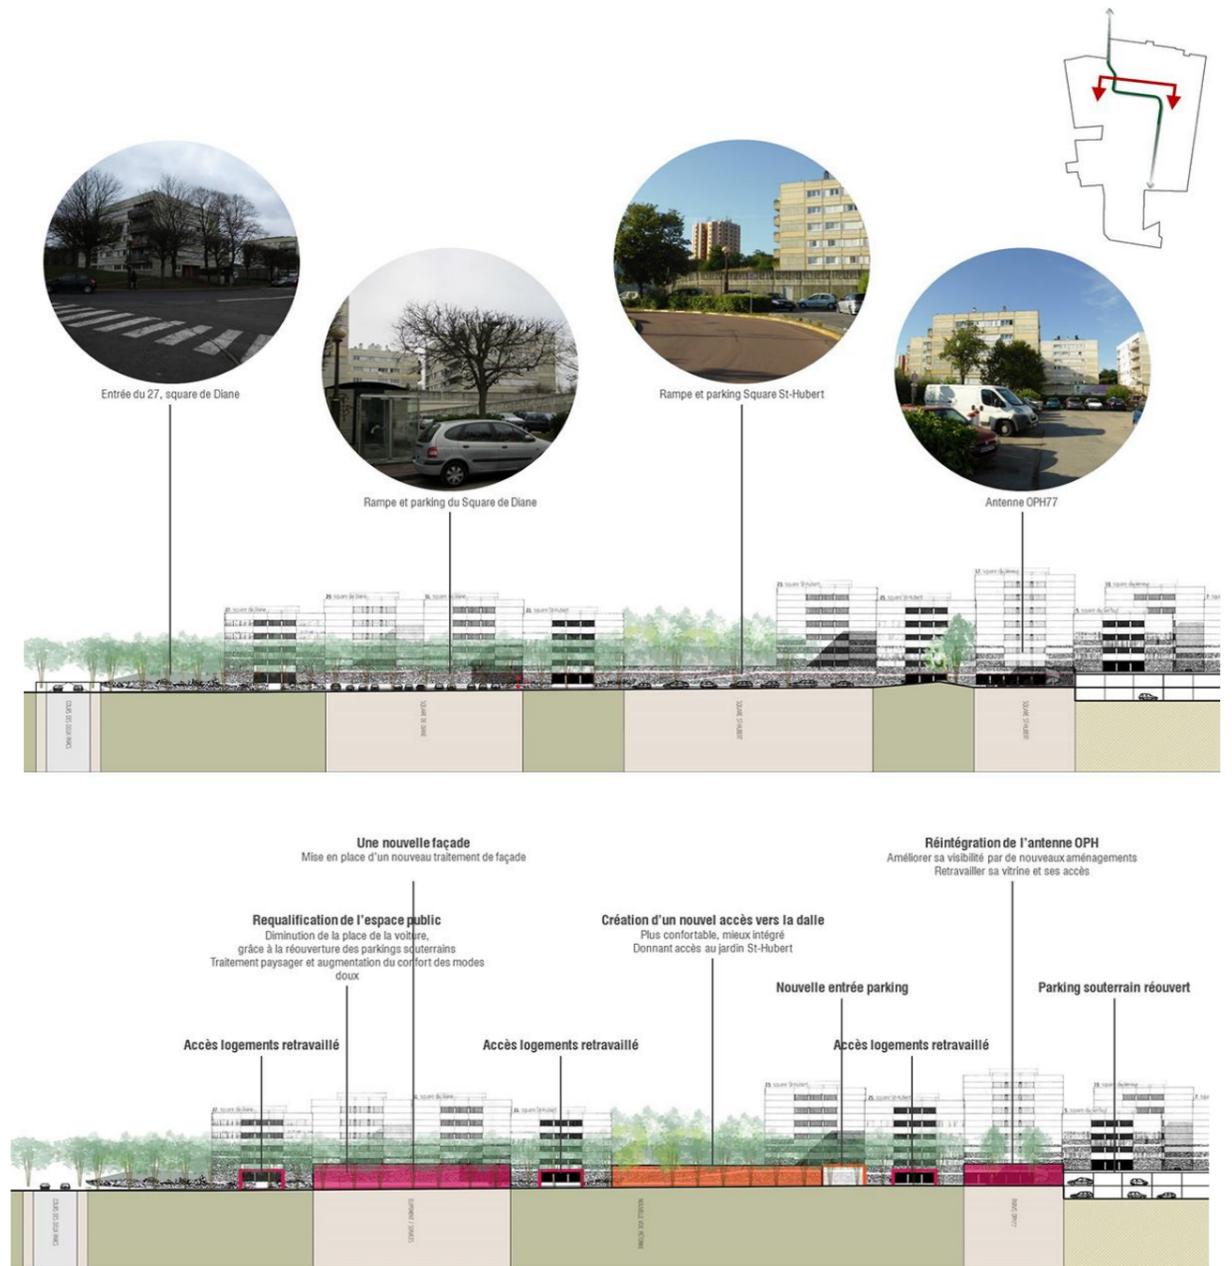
Façade de la dalle des Pommiers avant-après (La Fabrique Urbaine - avril 2017)
